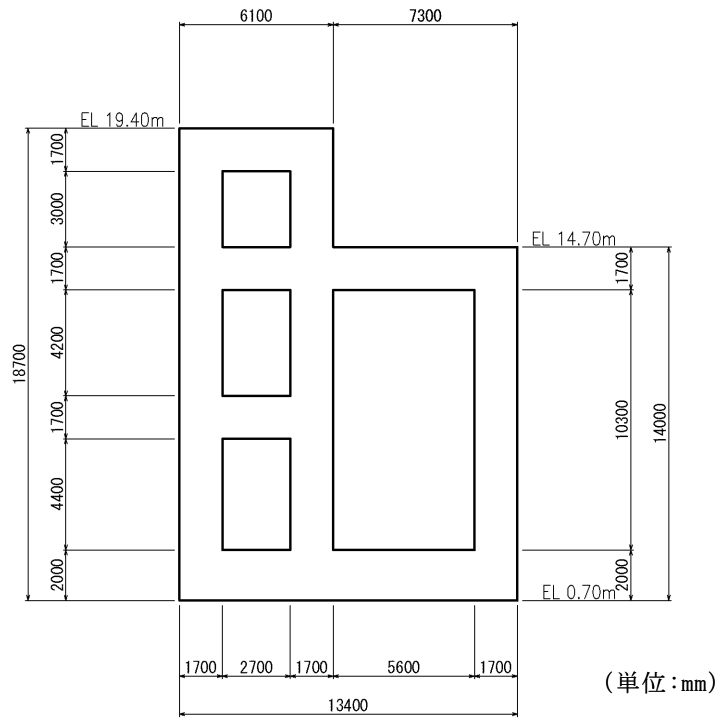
第 1 ベントフィルタ格納槽 断面図 (A-A 断面)
